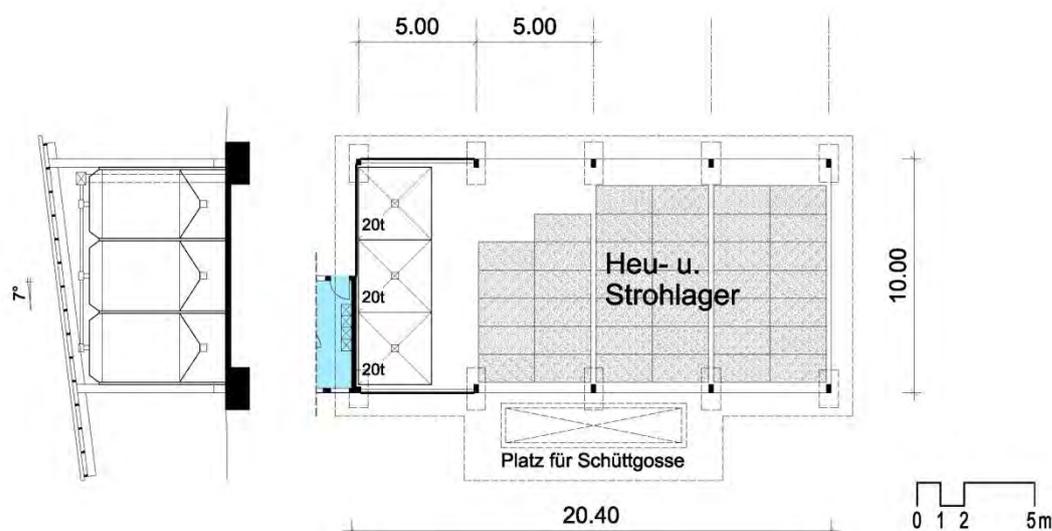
Grundriss und Schnitt der Bergehalle
